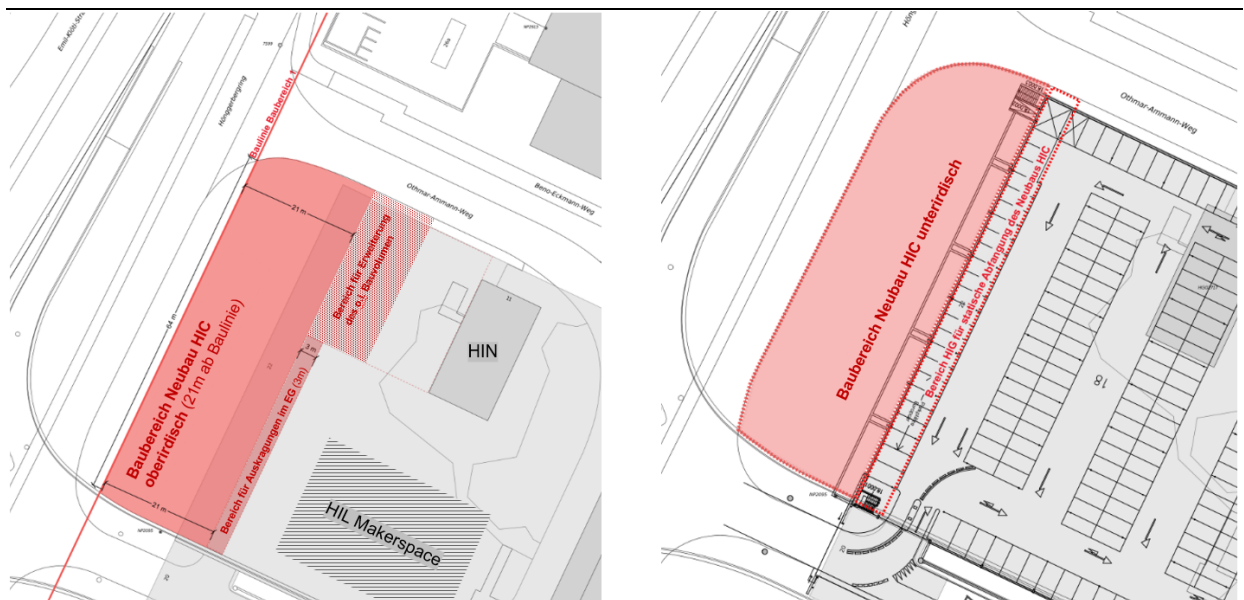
Übersicht Bauperimeter HIC Neubau oberirdisch (links) und unterirdisch (rechts)
